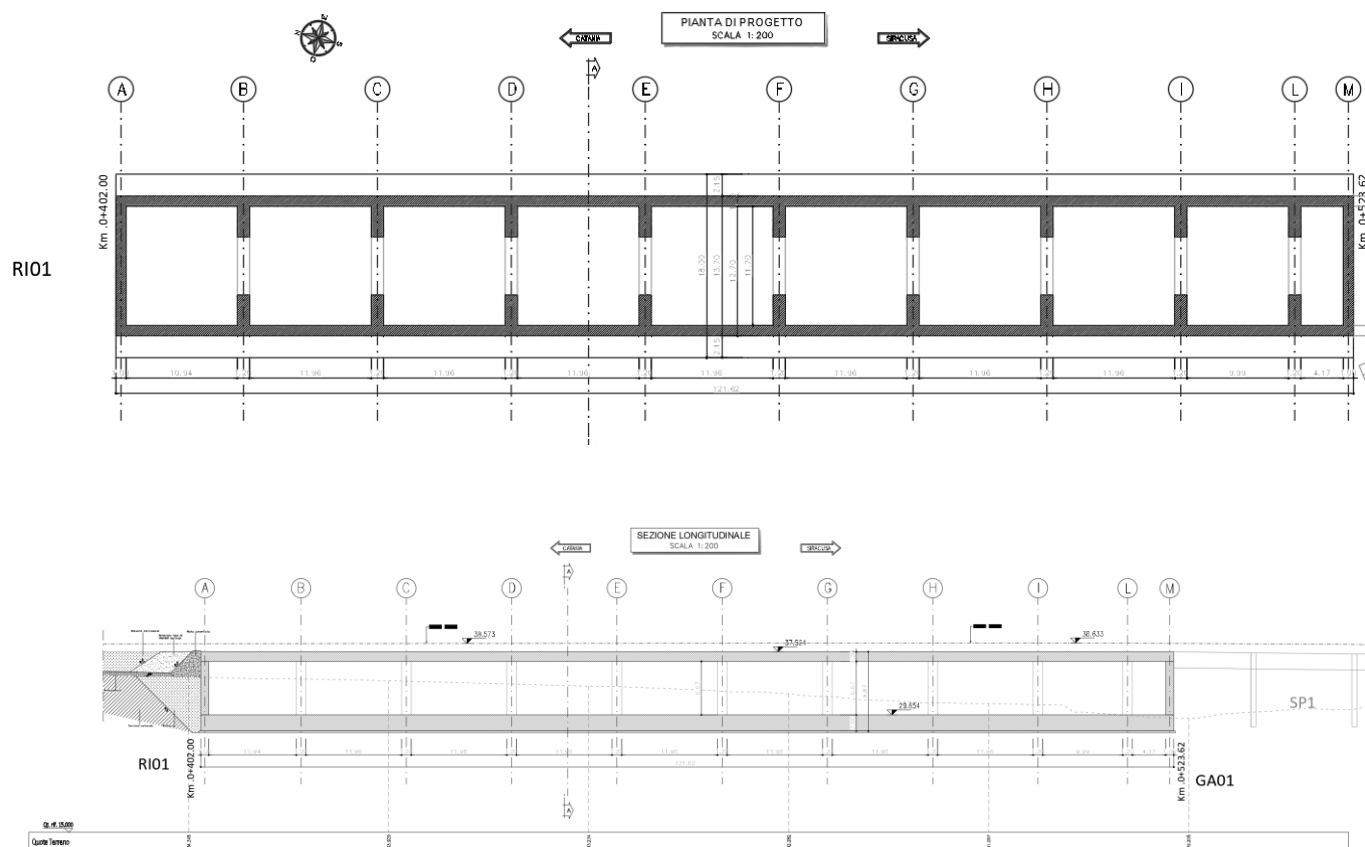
Planimetria e sezione longitudinale dell'opera in oggetto
